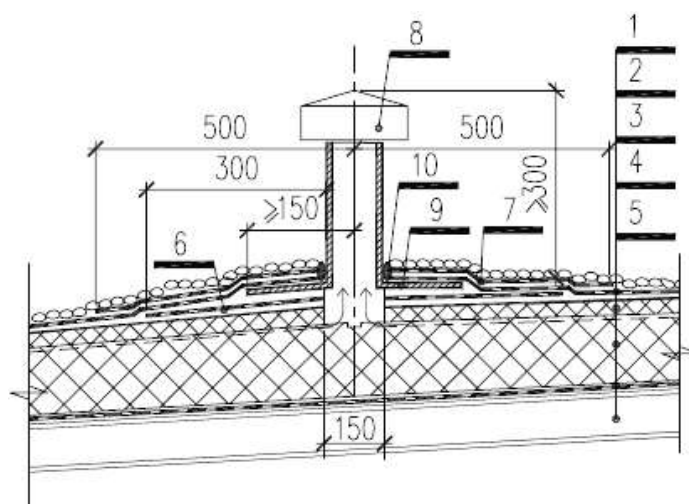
Установка аэратора на кровле по стальному профилированному настилу и теплоизоляции из жестких минераловатных плит: 1 – однослойный водоизоляционный ковёр; 2 – верхний слой жесткого утеплителя; 3 – нижний слой утеплителя; 4 – пароизоляция; 5 – стальной профилированный настил; 6 – нижний дополнительный слой рулонного материала; 7 – верхний дополнительный слой; 8 – аэратор; 9 – фланец аэратора; 10 – герметик
